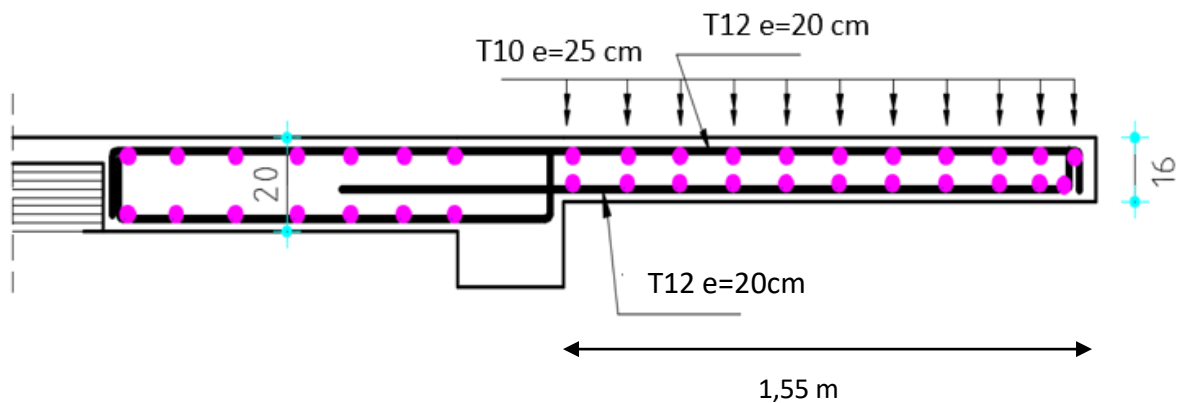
schéma de ferrailage du balcon avec contre poids.
